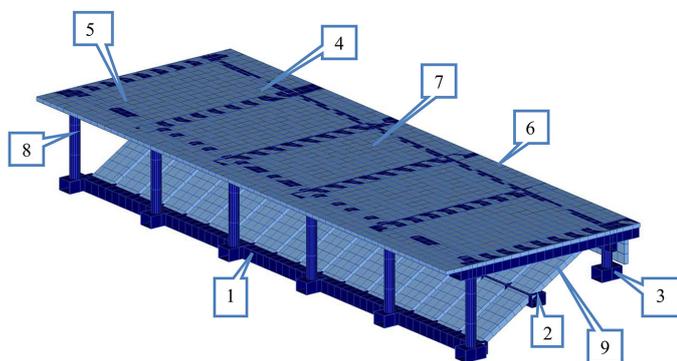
Схема конструкций променада без свай (конечноэлементная модель): 1 – нижний ростверк; 2 – средний ростверк; 3 – верхний ростверк; 4-6 – балки плиты променада; 7 – плита променада; 8 – колонны; 9 – лестничная конструкция
